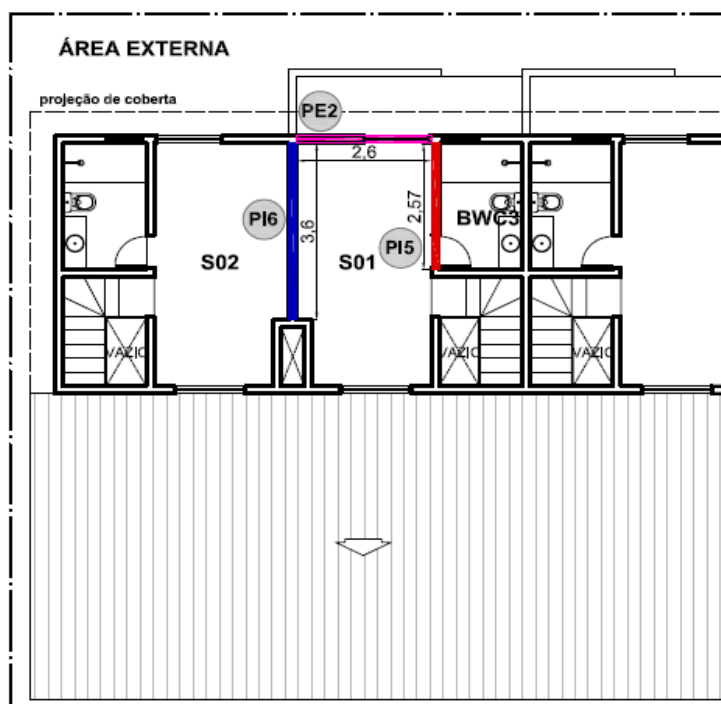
Planta baixa do Objeto 02 (pavimento superior) com as paredes avaliadas nos ensaios em campo.
